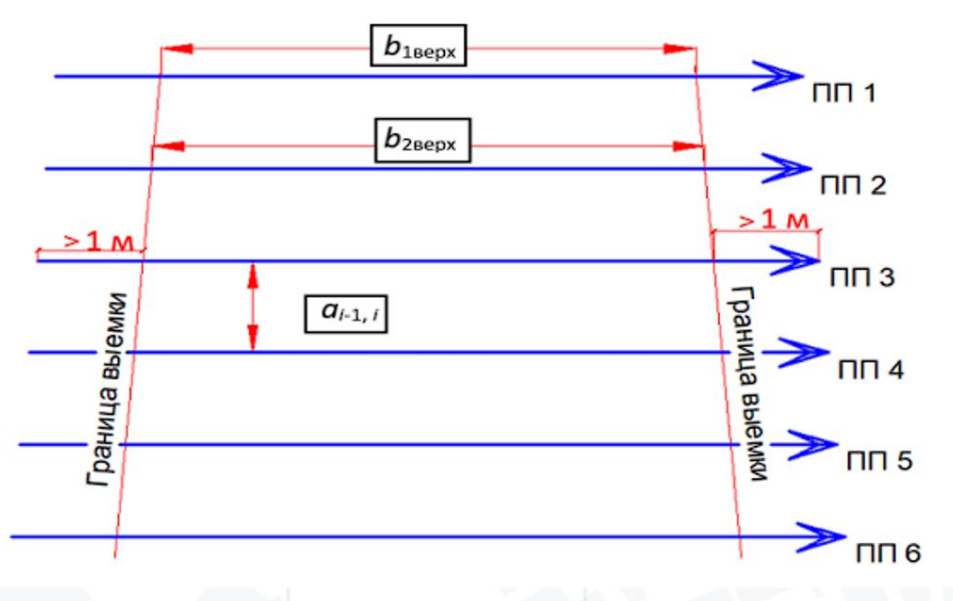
Схема расположения поперечных георадарных профилей (вид сверху)
